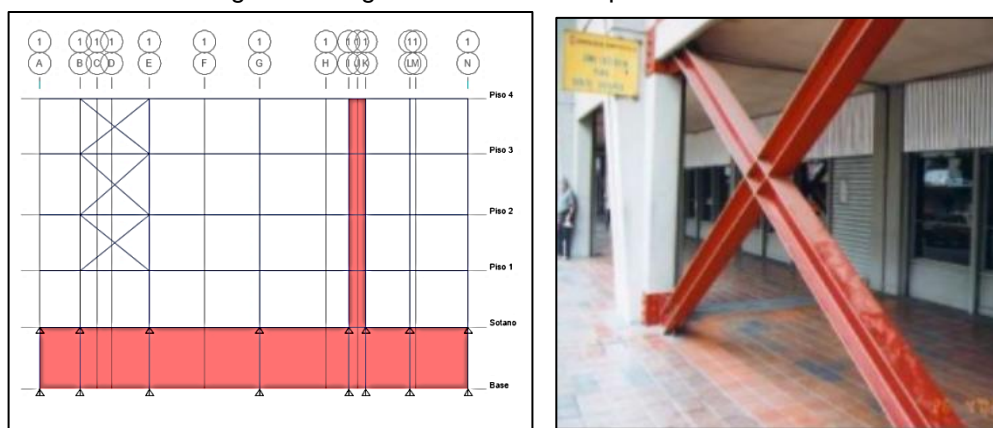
columnas en 1er. piso que requieren reforzamiento.
